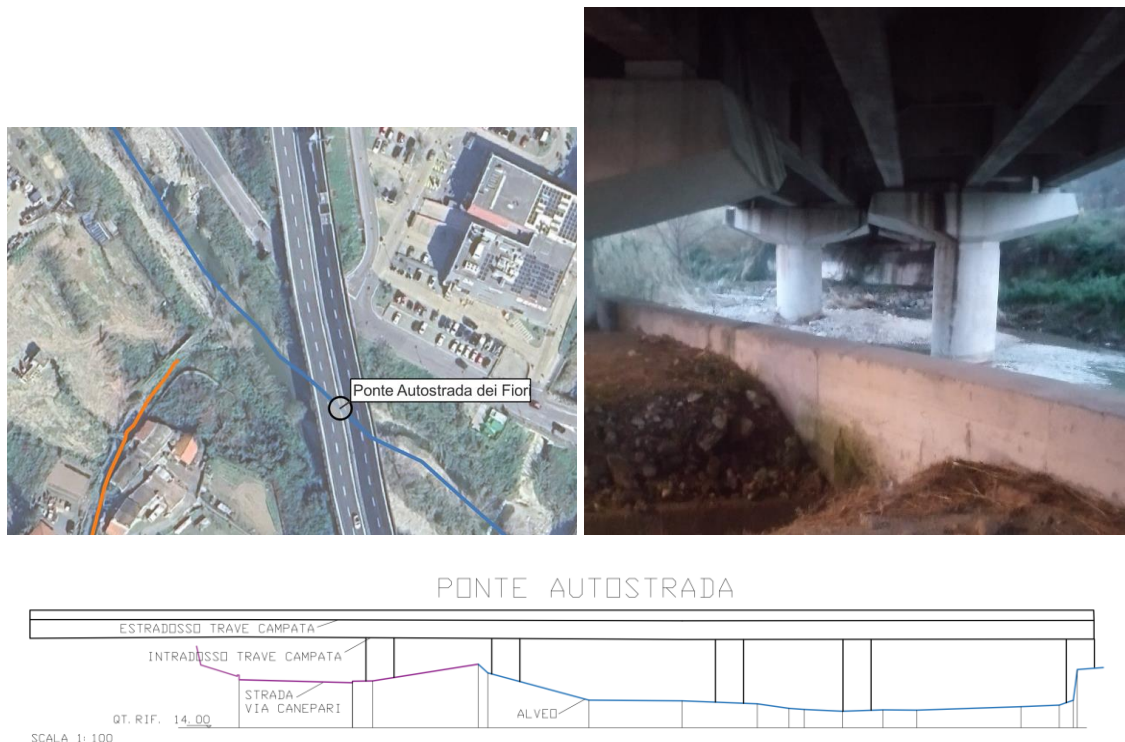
Ponte dell'autostrada dei Fiori (CLV\_31): ubicazione planimetrica, foto di dettaglio vista dalla strada Via Canepari e schema della sezione rilevata per il modello.
